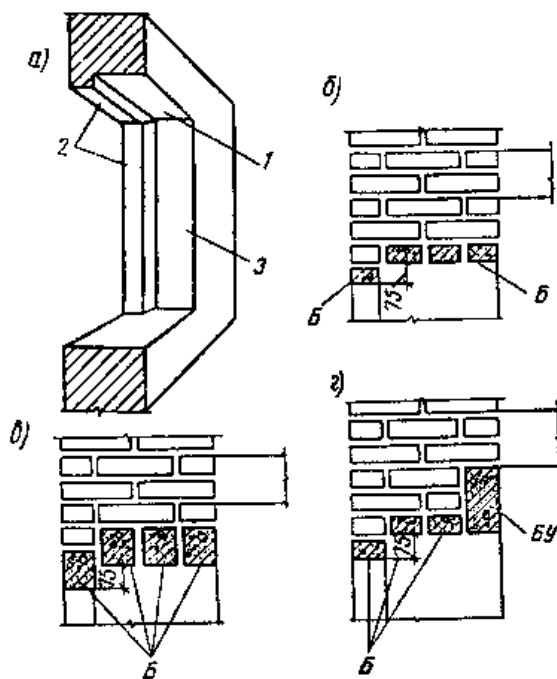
Перекрытие проемов в кирпичных стенах:
